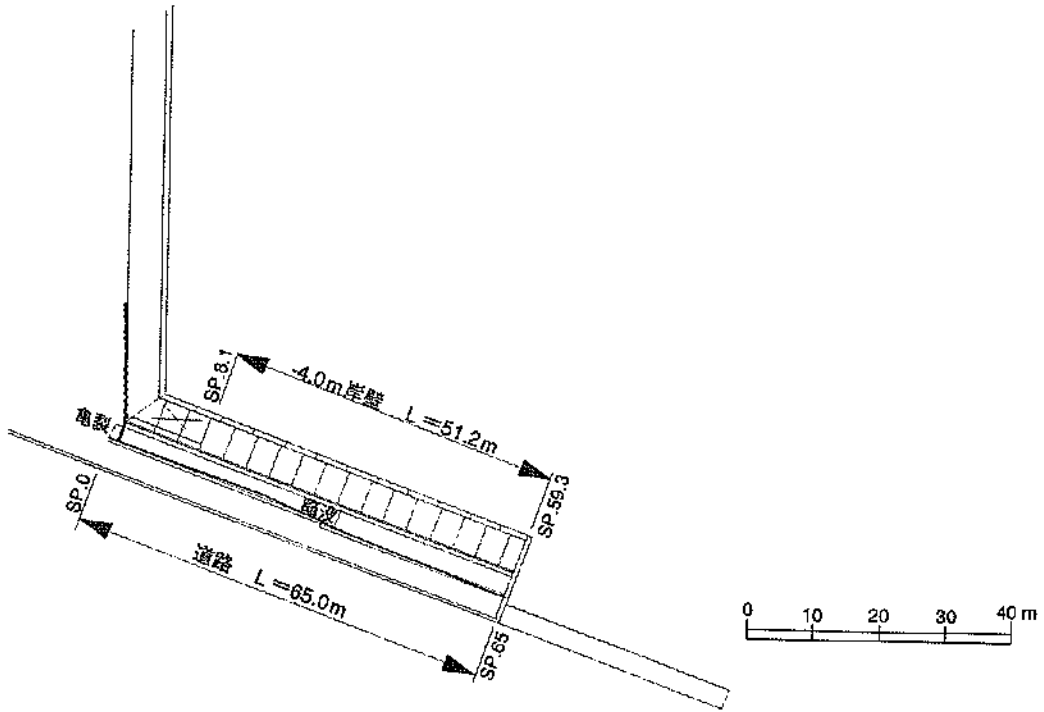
大樹漁港①-4.0m岸壁および道路被災状況平面図
